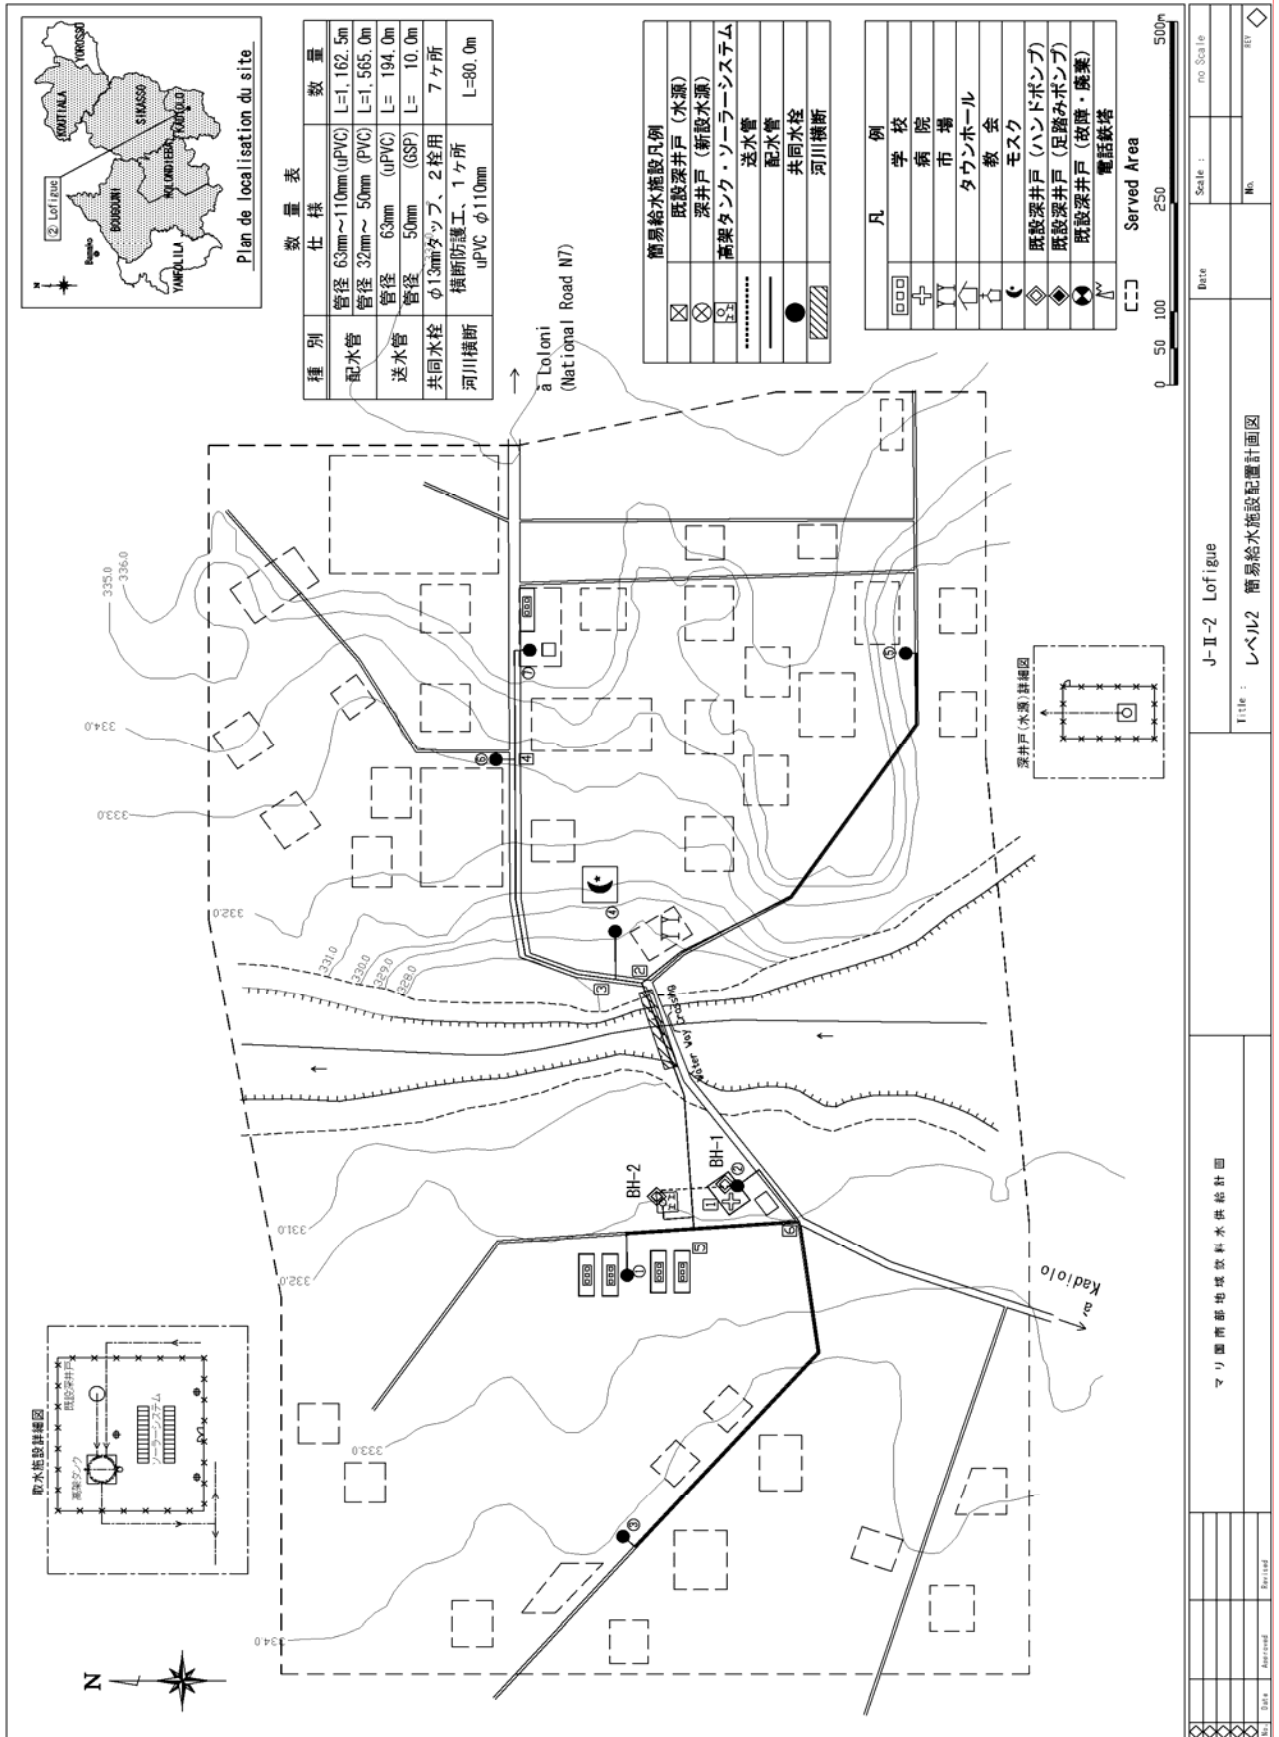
レベル 2 給水施設配置図 (J-II-2 Lofique)
